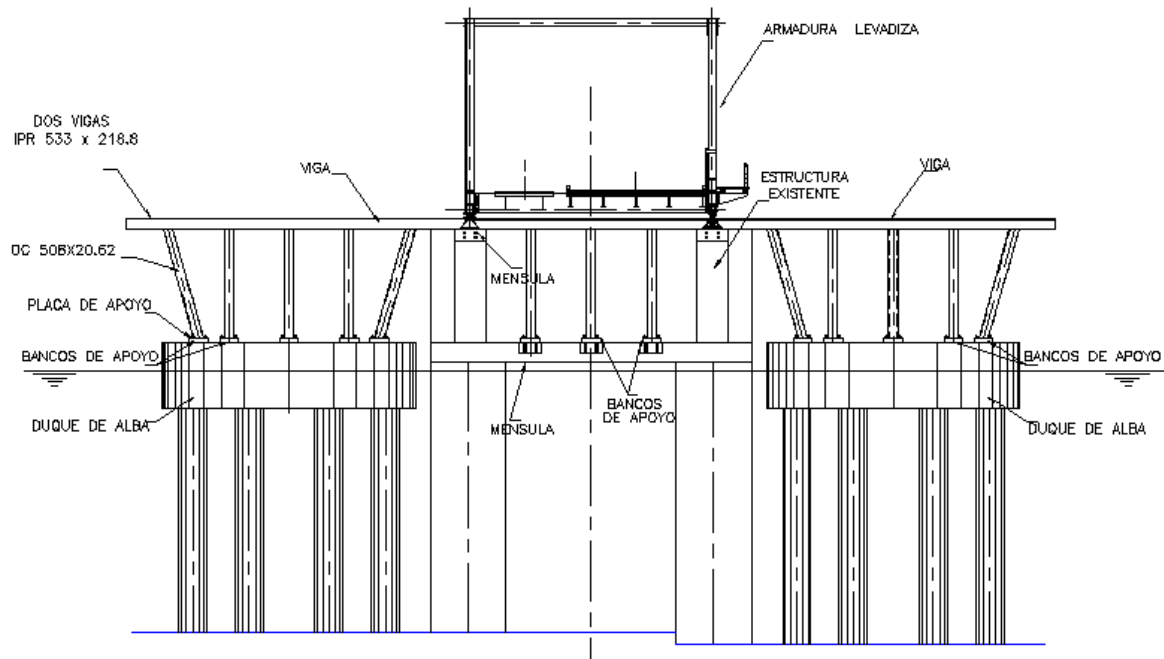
Detalle de la estructura temporal sobre los duques de alba [1.3].
